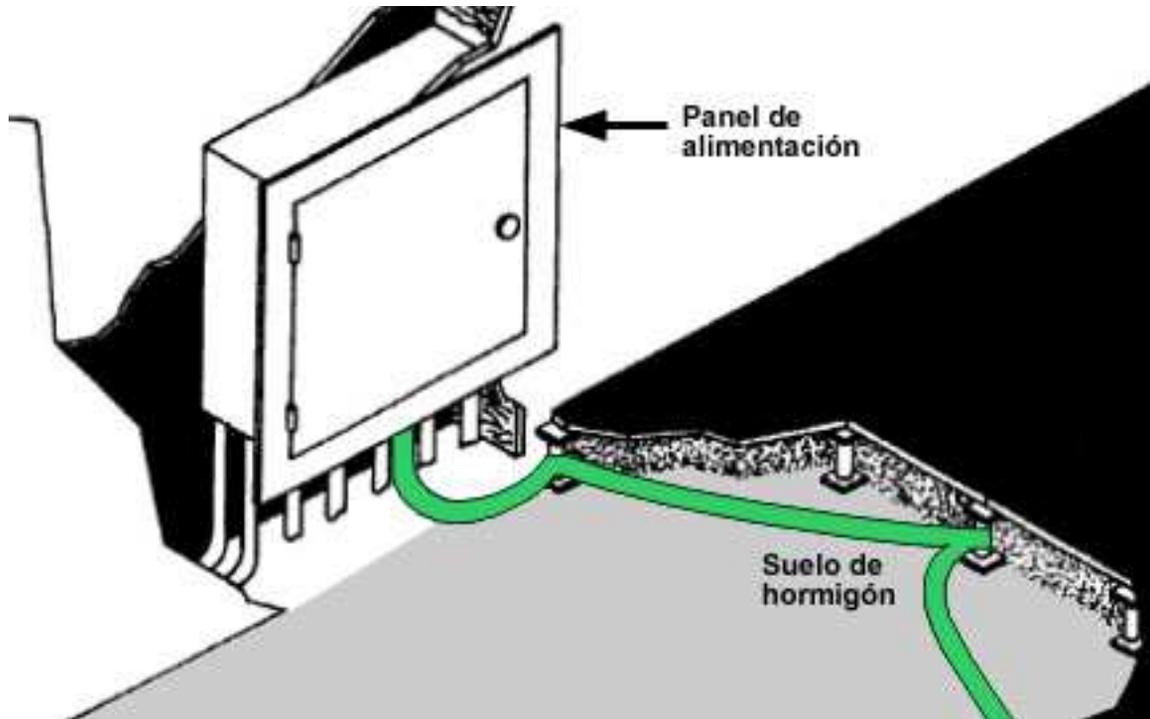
Toma de tierra temporal utilizando la estructura de soporte del pavimento elevado
